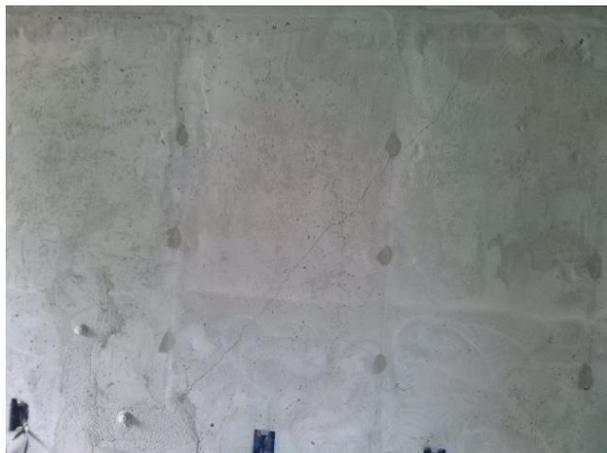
Fissura a 45º do negativo do painel (Fonte do autor)
